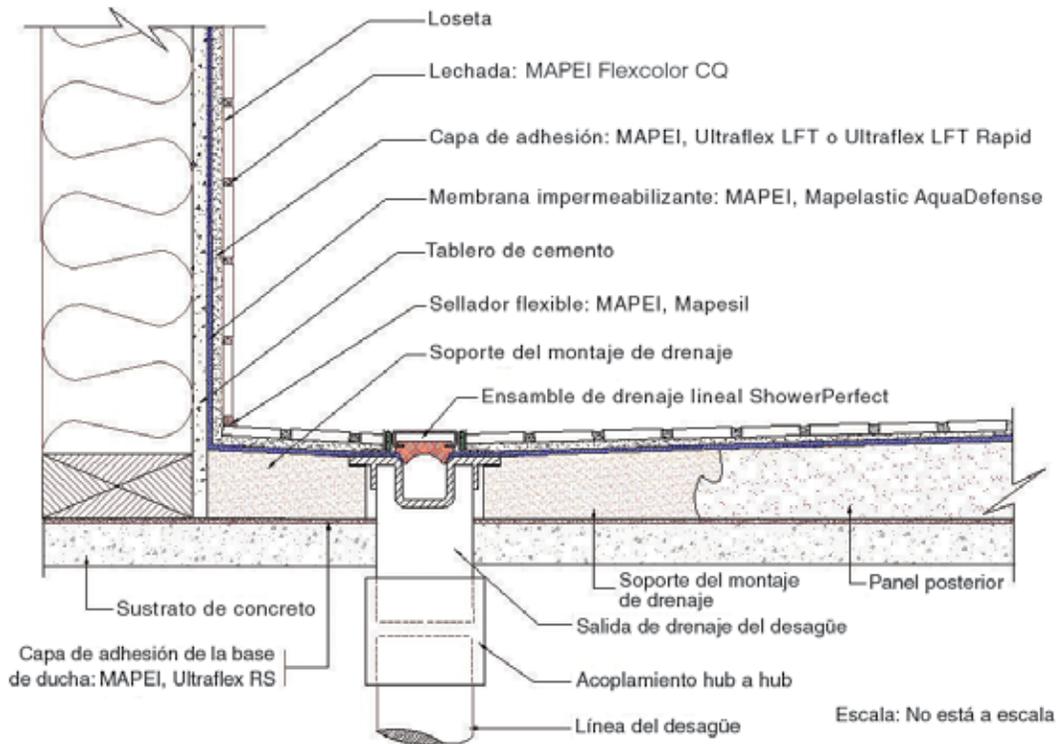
Ensamble de drenaje – vista del ensamblado
